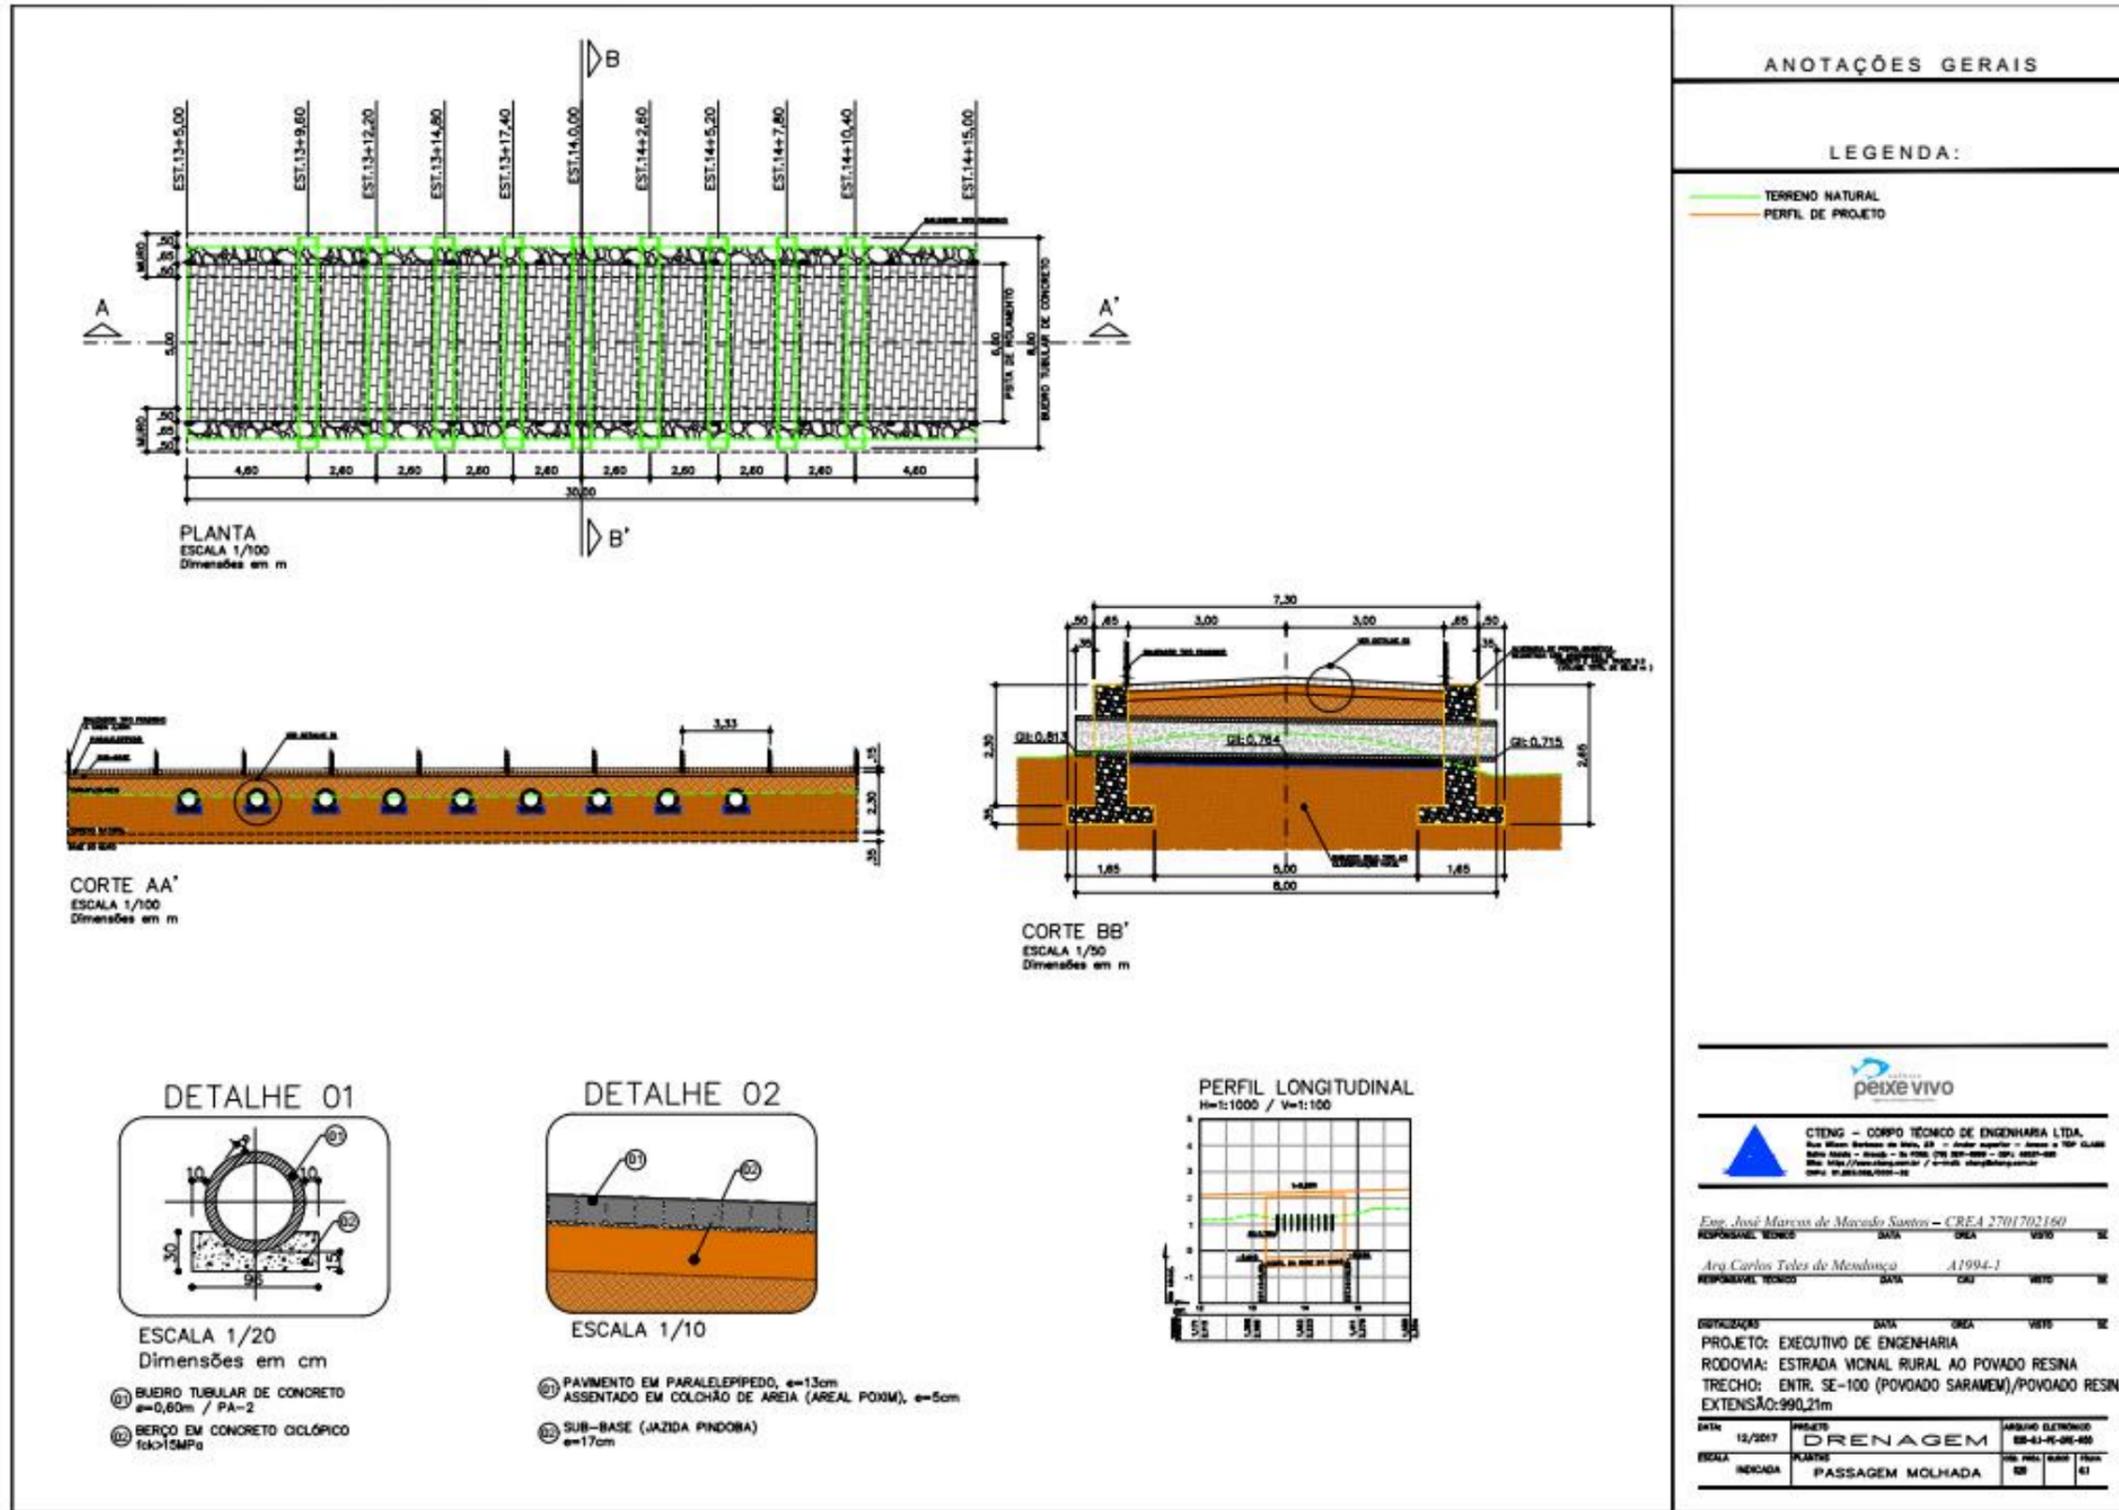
a - Detalhe para execução de passagem molhada (drenagem).
